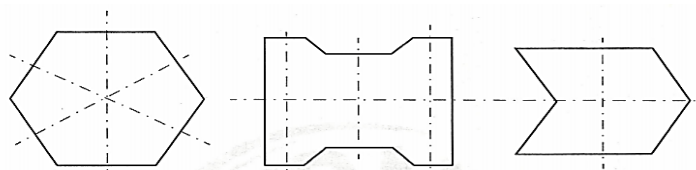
Peças de concreto pré-fabricadas do tipo III [14].
